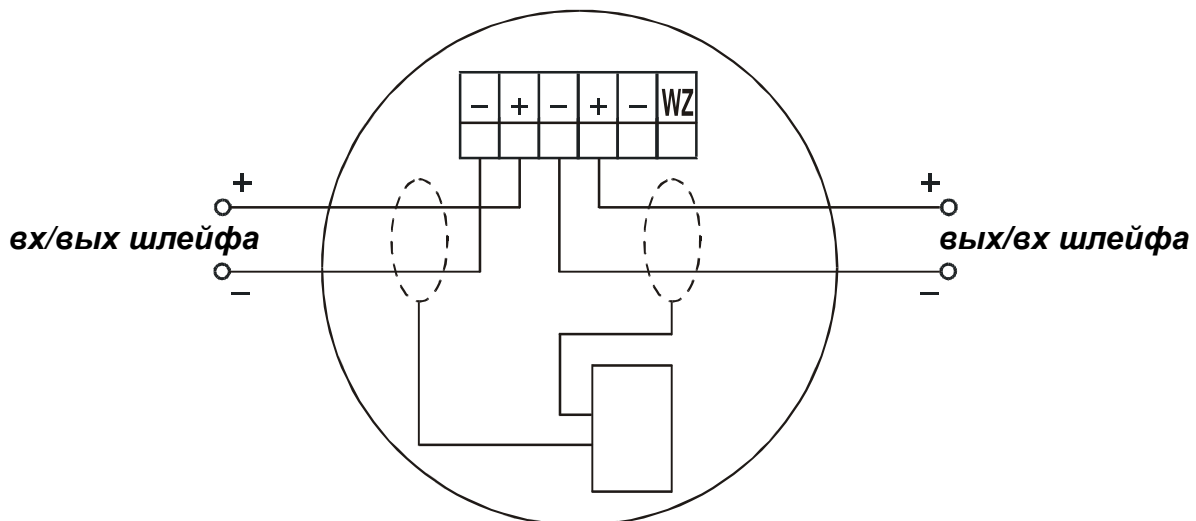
Зажимы розетки, работающей совместно с вилкой извещателя
